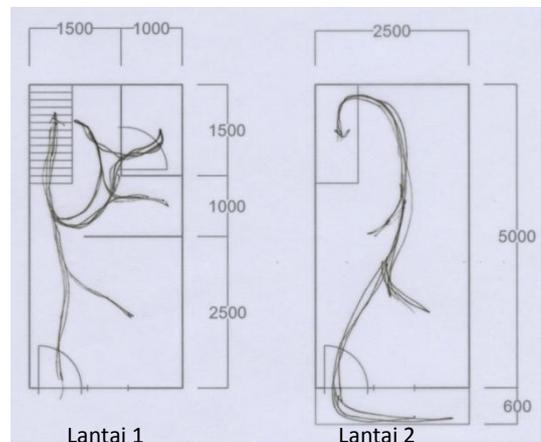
denah lantai 1 rumah mbak Ynj
